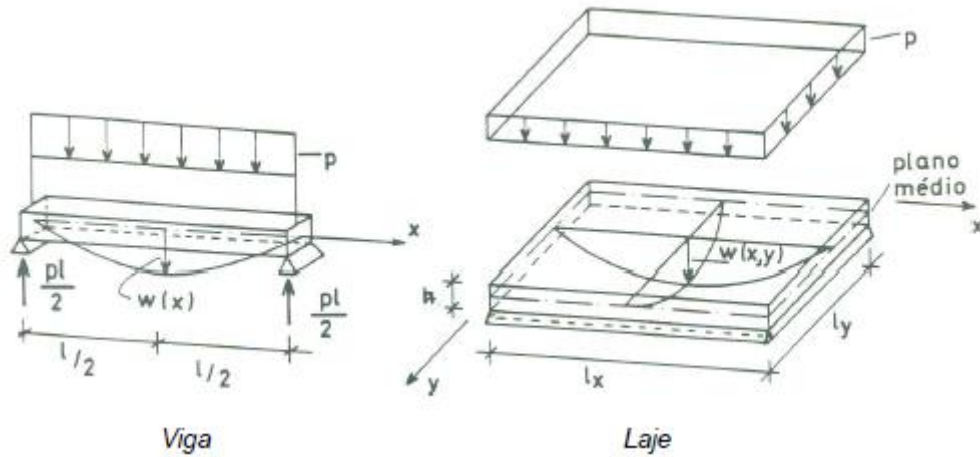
Comportamento à flexão de uma viga e de uma laje [20]
